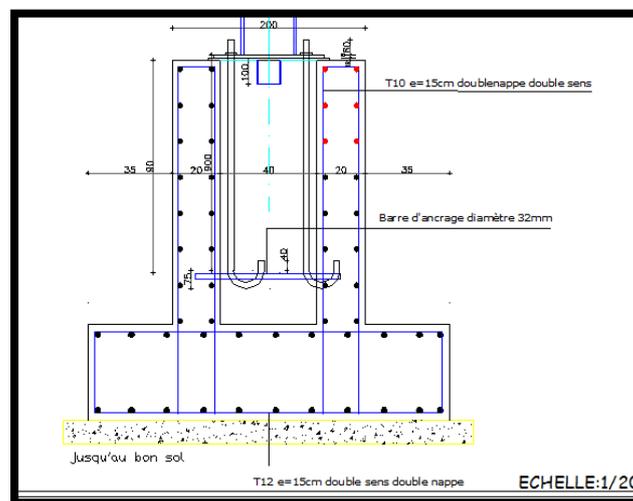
Le système d'encrage d'un poteau métallique dans une semelle isolée
